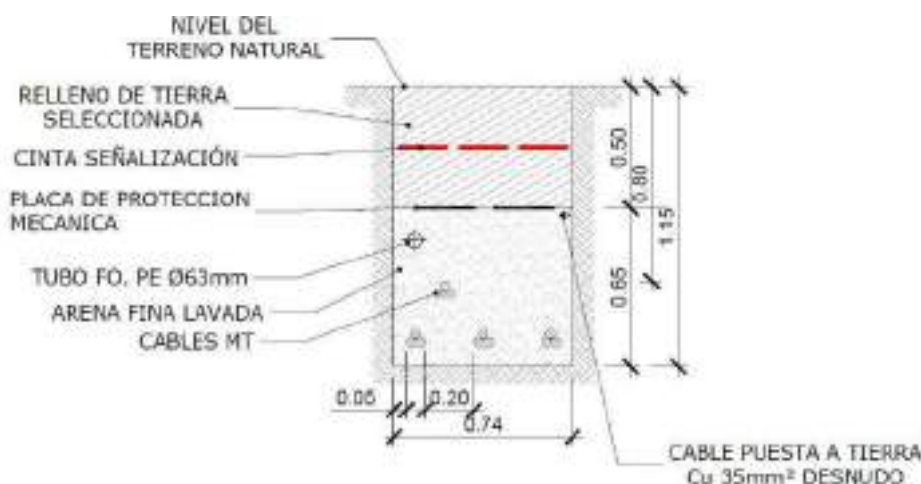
Zanja MT 4 ternas cables directamente enterrados
